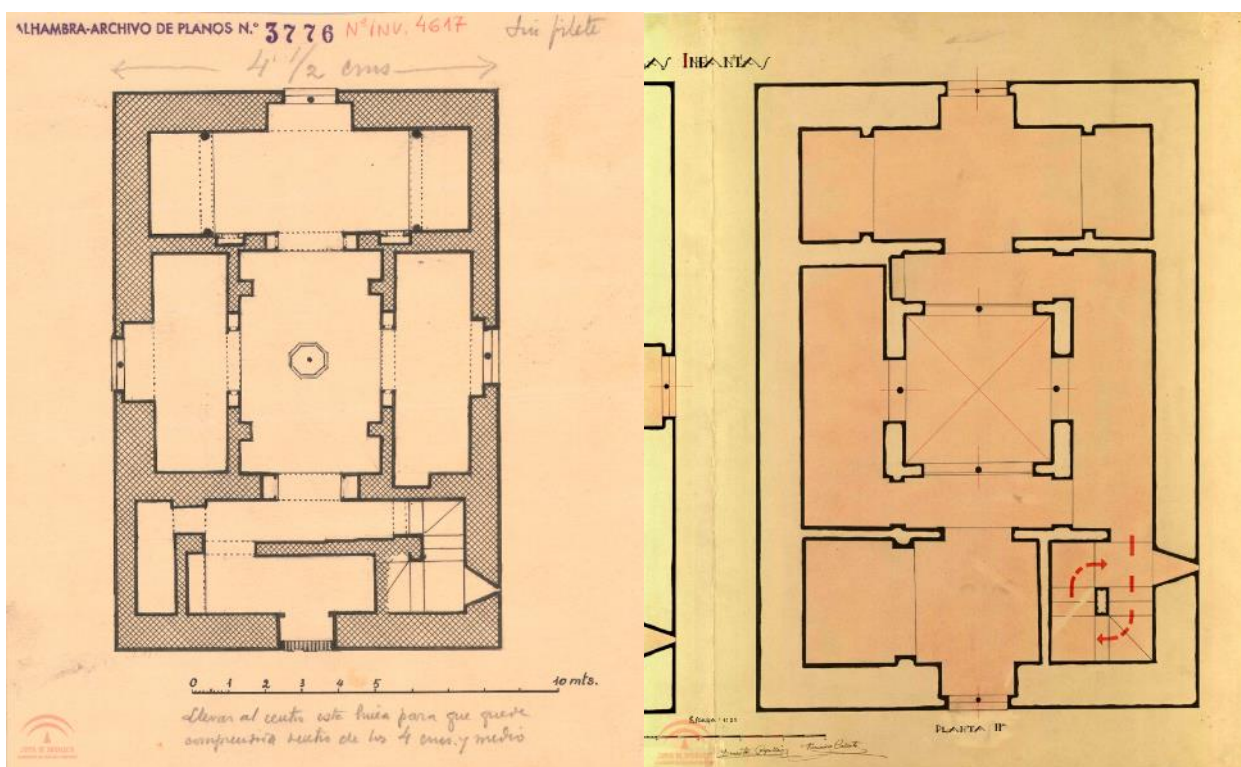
Torre de las Infantas: Planos de planta baja y segunda
